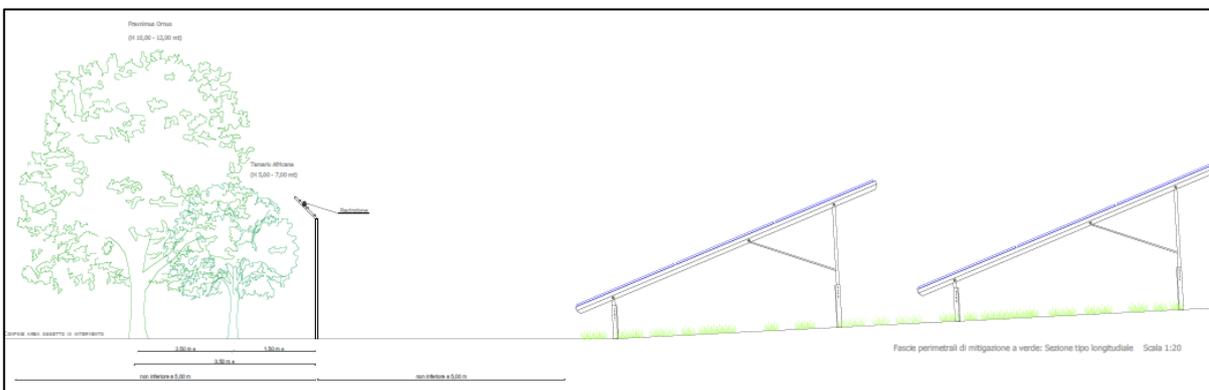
Layout fascia di mitigazione perimetrale- Sezione
